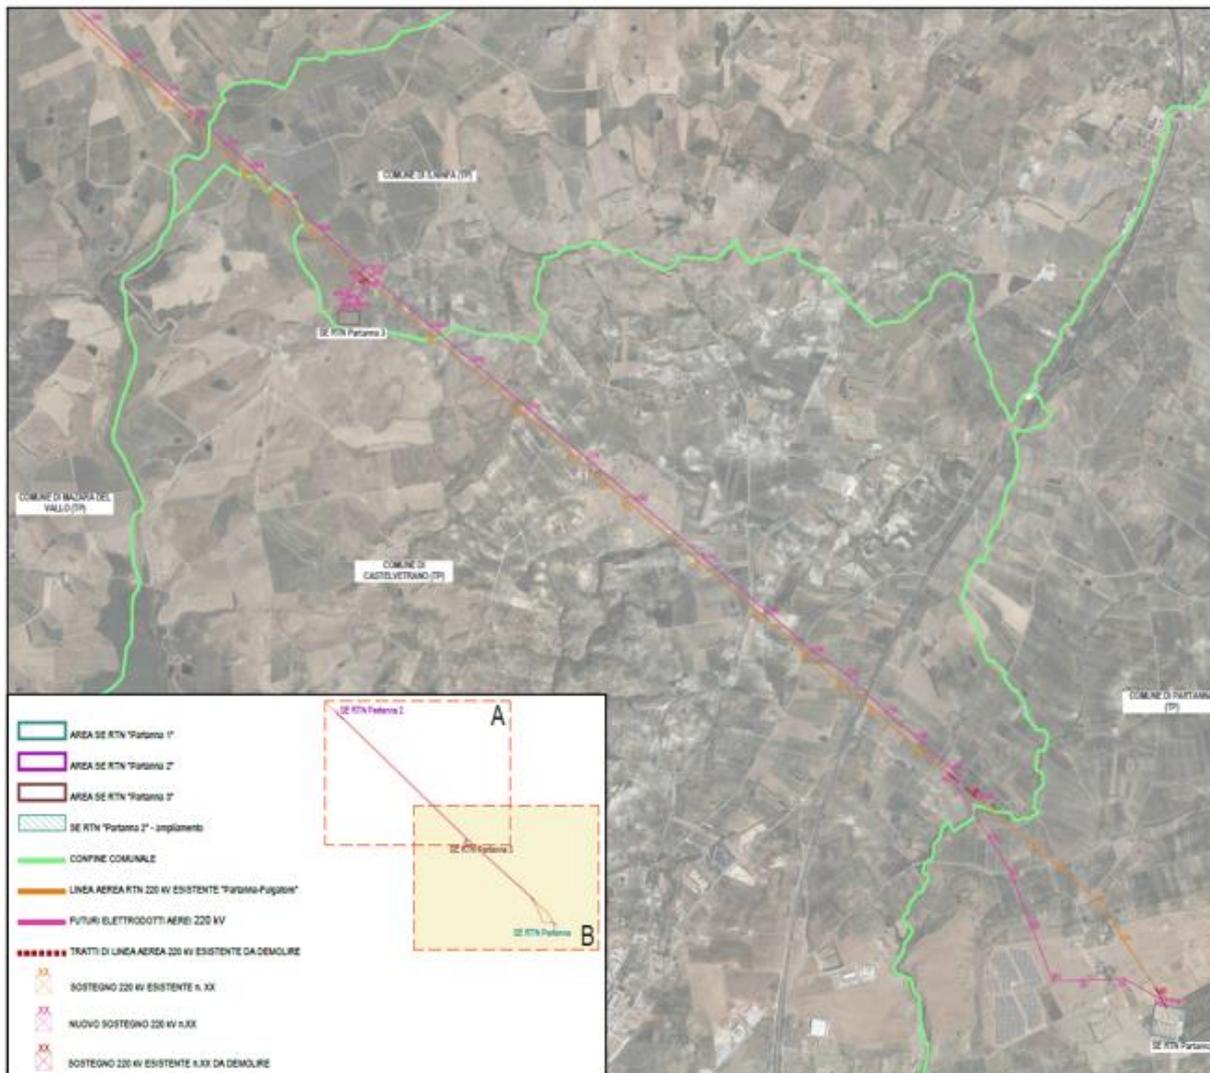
Inquadramento opere di rete su ortofoto Tav.B (Scala 1:10000).
